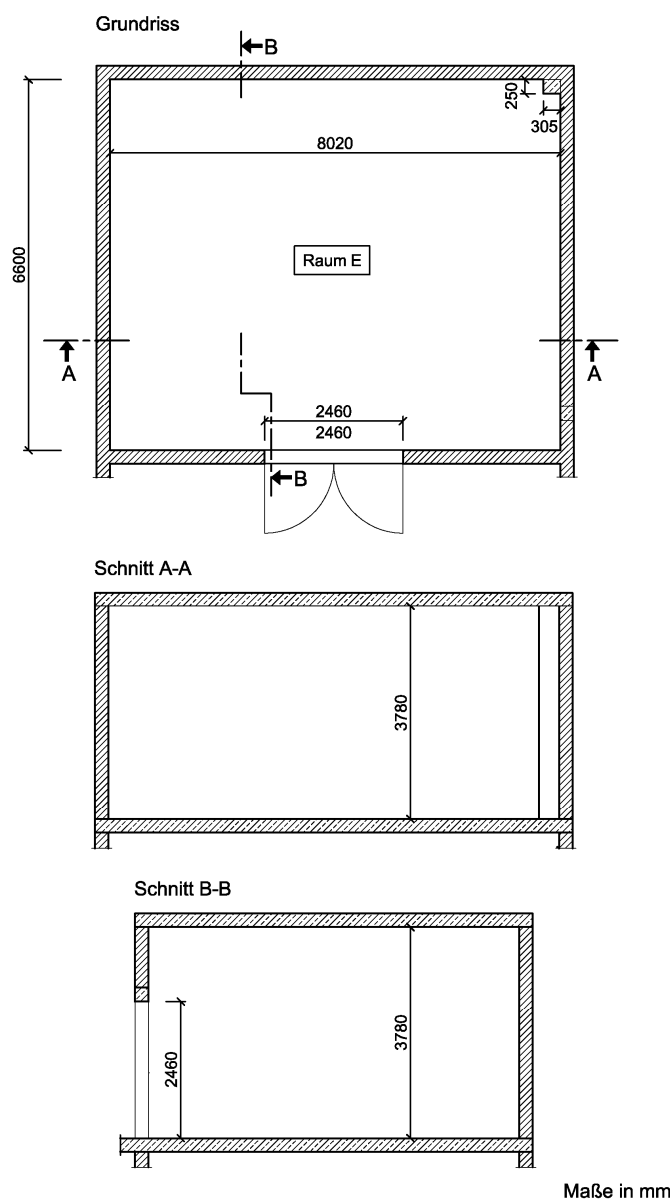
Grundriss und Schnitte des Hallraums.
